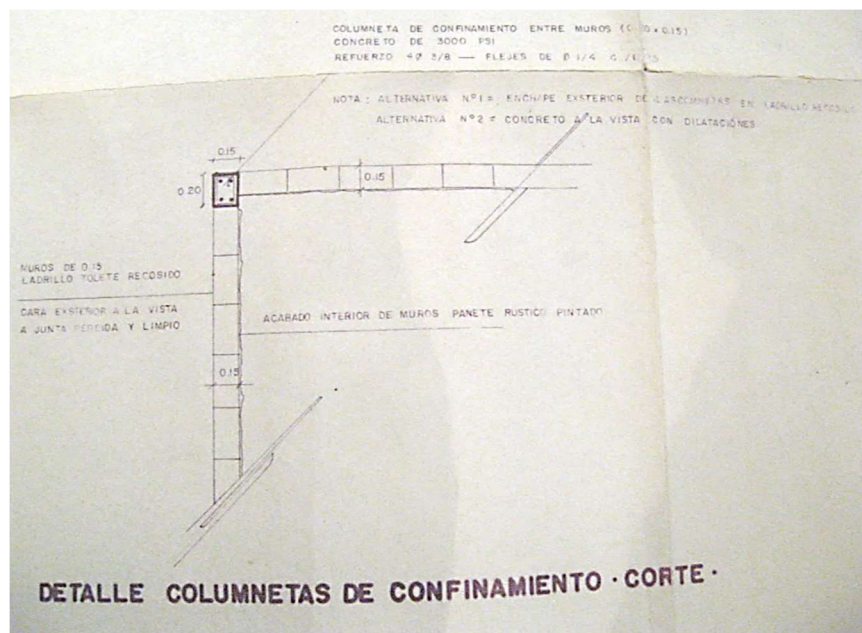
Detalle estructural no ejecutado en obra (archivo propio)
